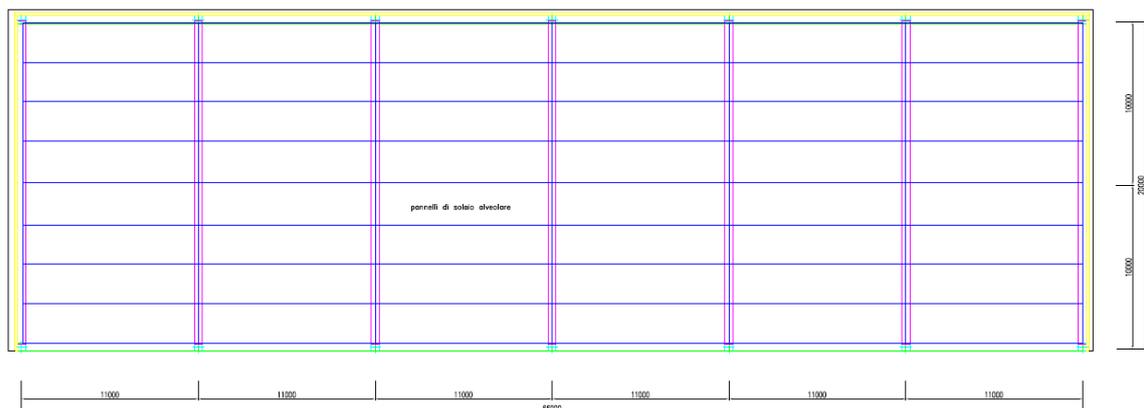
Pianta della nuova Tettoia di Stoccaggio del CSS (STR-12)
